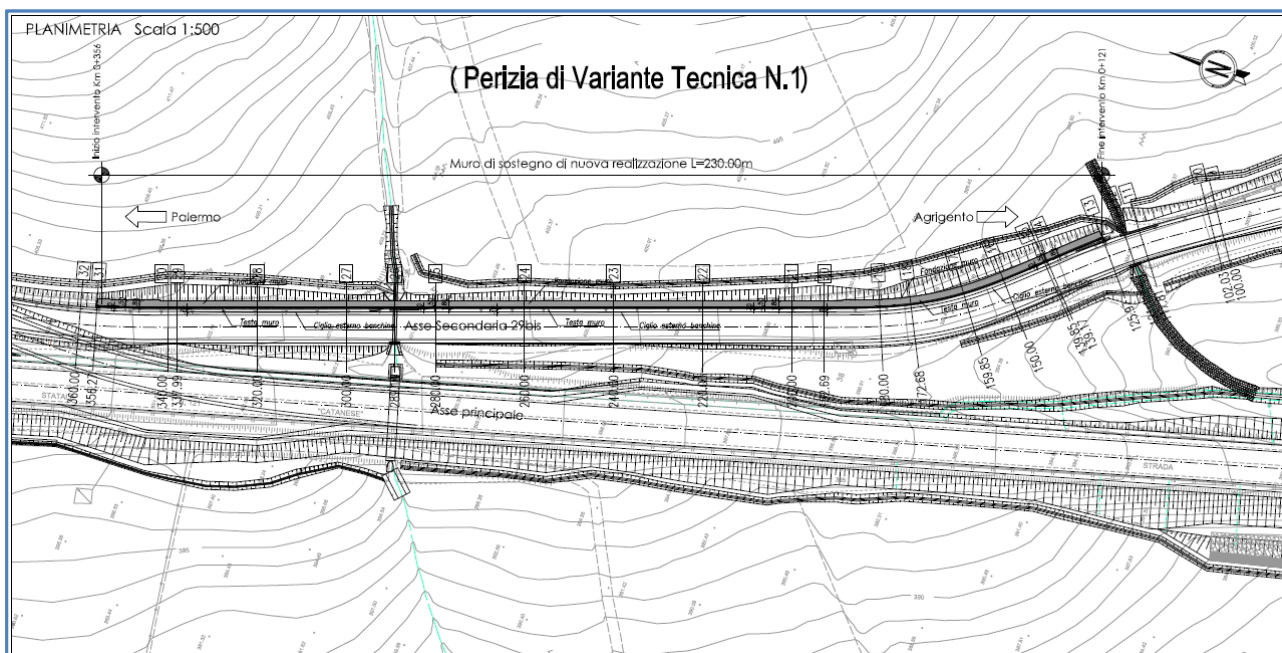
Stralcio planimetrico con l'ubicazione del nuovo muro di sostegno secondo le previsioni di P.V.T.1 – Elaborato codifica PVVS\_W002\_50\_4137.
